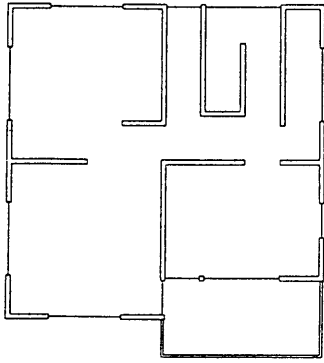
解析対象建築物平面図 (No.21, No.22)
